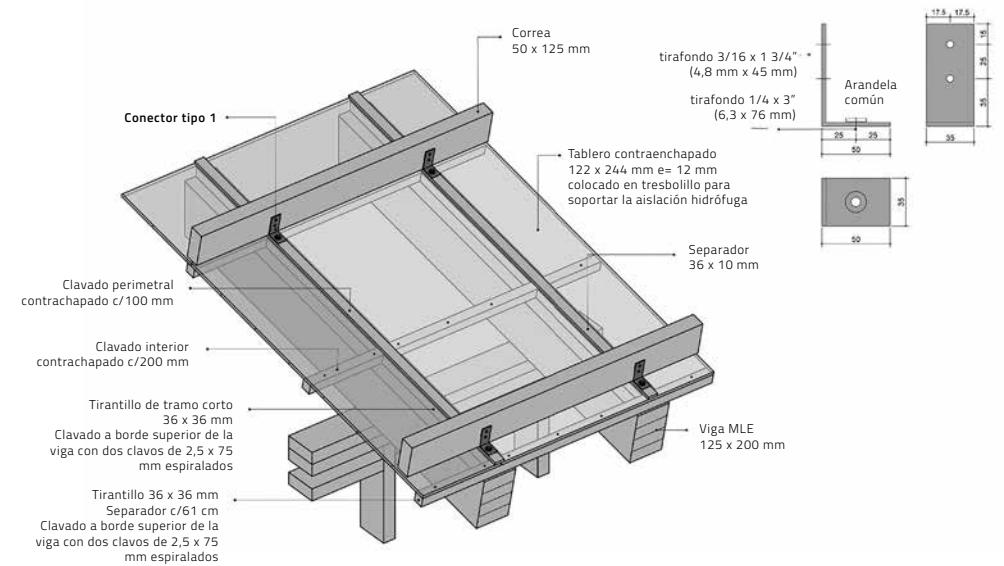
CUBIERTA CON VIGAS DE MADERA LAMINADA ENCOLADA. FUENTE: DOCUMENTO COMENTADO EN EL ARTÍCULO
